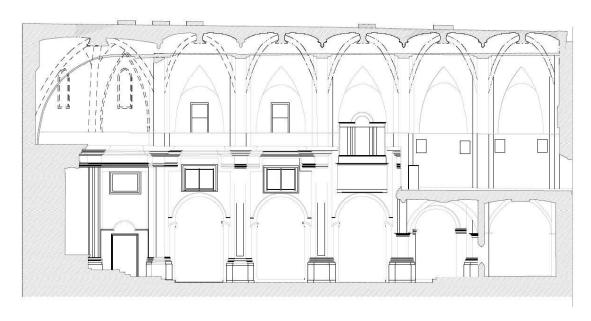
Sección longitudinal central B-B' ELABORACIÓN PROPIA
